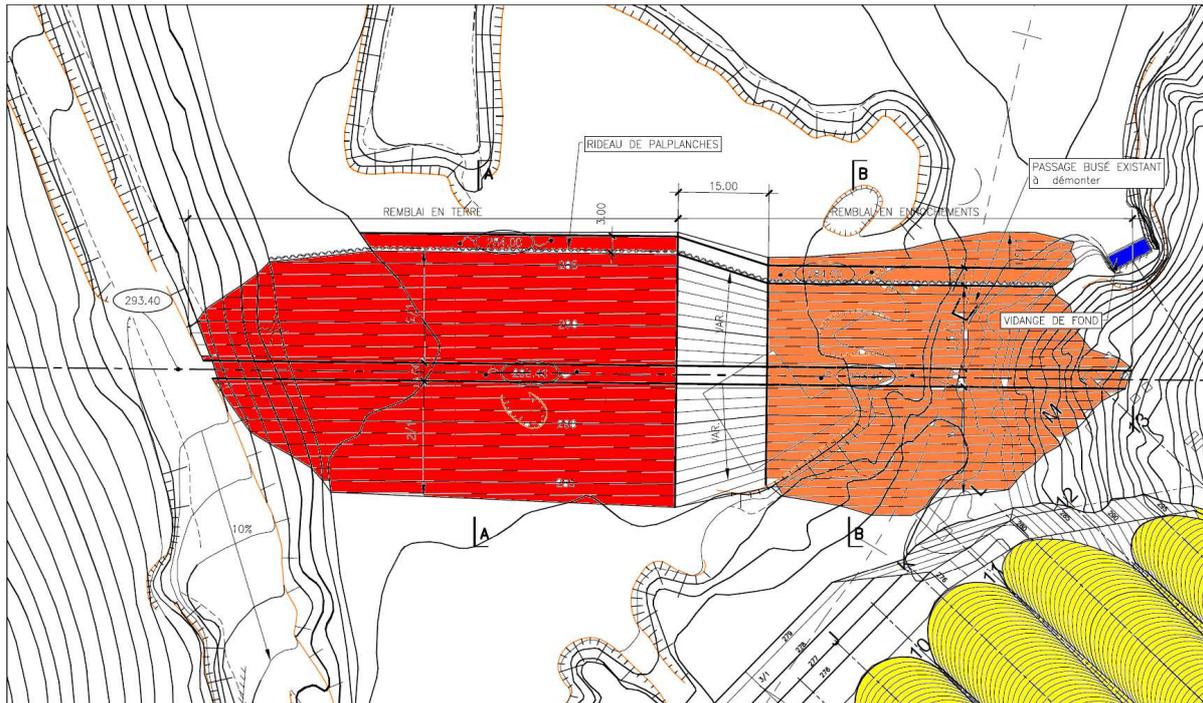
Vue en plan de l'implantation du batardeau du projet avec talus raidis en rive gauche (pied du barrage existant en aval)
